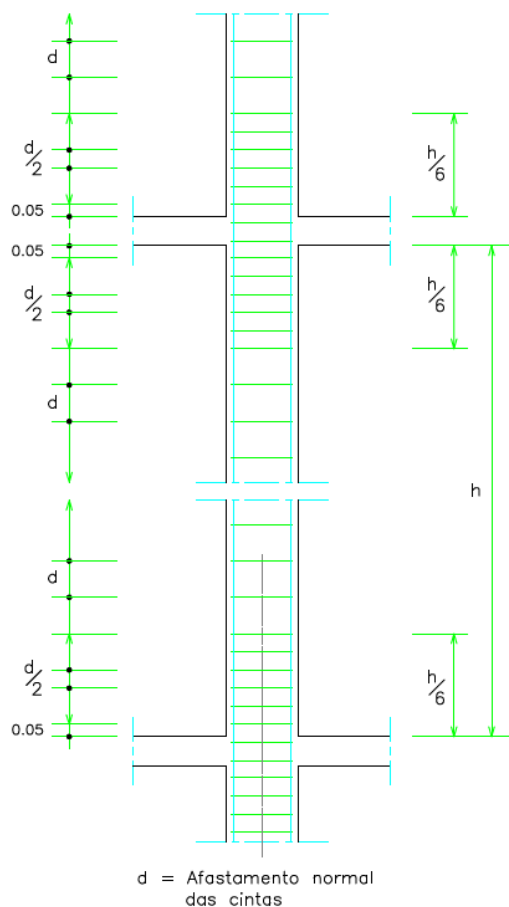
Esquema de distribuição de cintas nos pilares – Projeto Tipo 3000 EDPD
